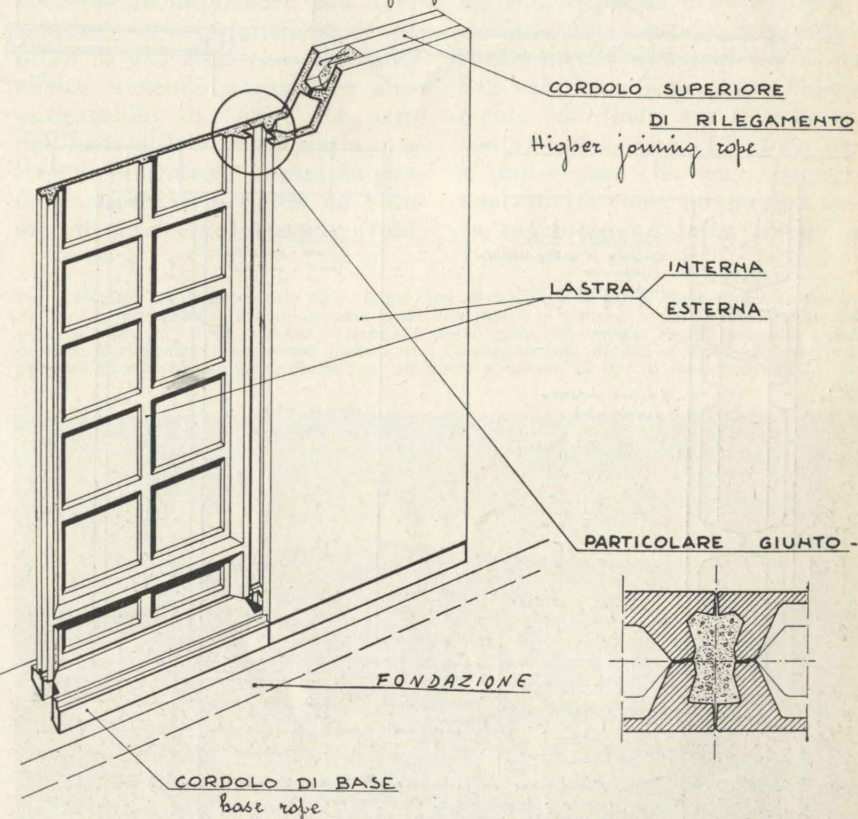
Schema di montaggio della parete a cassa vuota portante secondo il sistema S.A.C.I.S.
